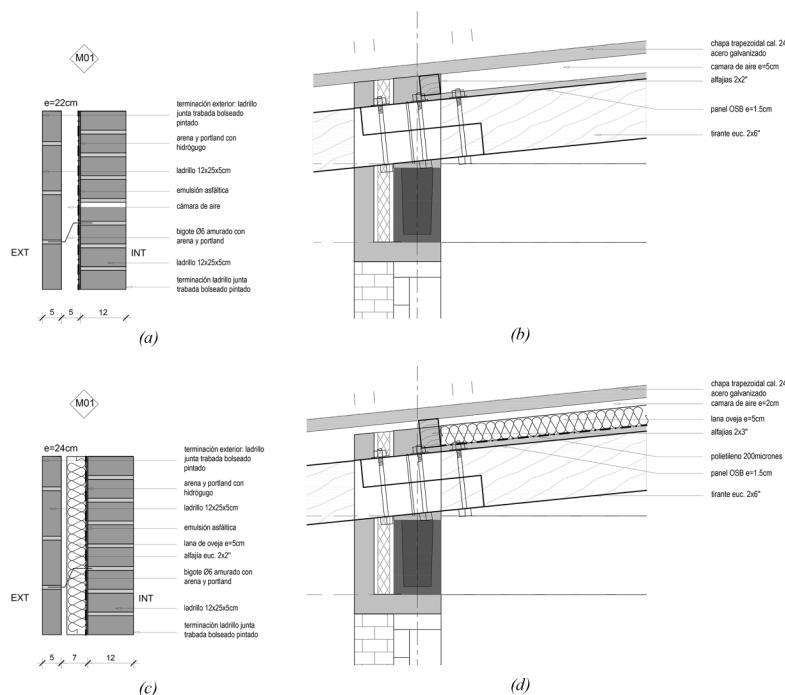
Detalles constructivos para MB y MA, (a) muro exterior, (b) cubierta, (c) muro exterior aislado, (d) cubierta aislada
